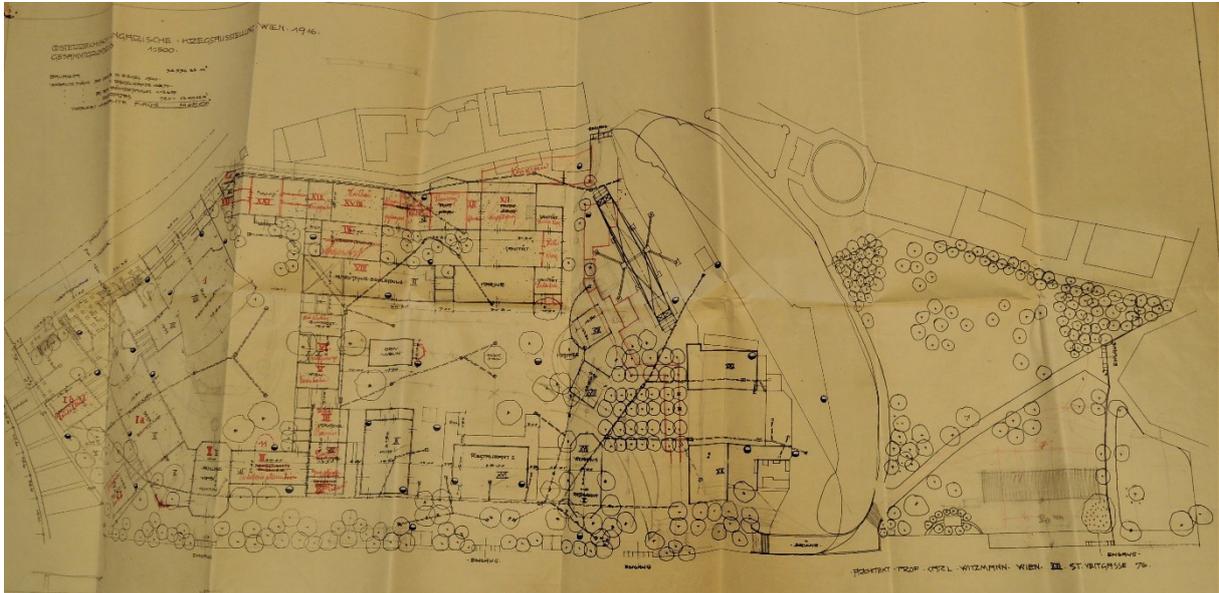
Grundriss des Ausstellungsgeländes 1916 mit den in rot markierten Änderungen (1916)
